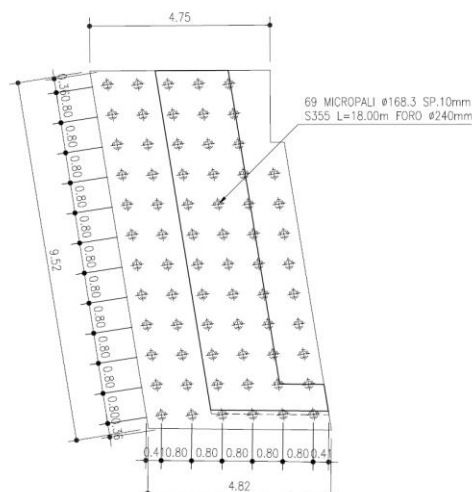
Spalla – Pianta Fondazioni
